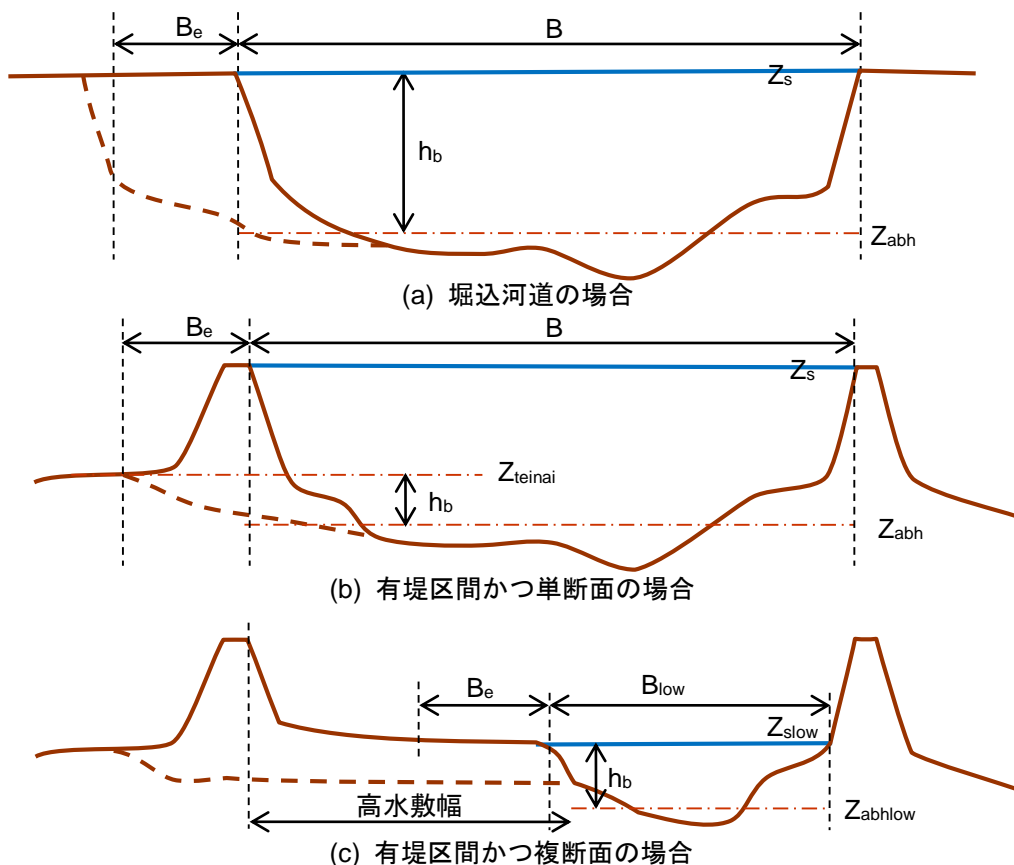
横断面図から読み取る川幅 B 、河岸高 h_b 、平均河床高 Z_{abh}
